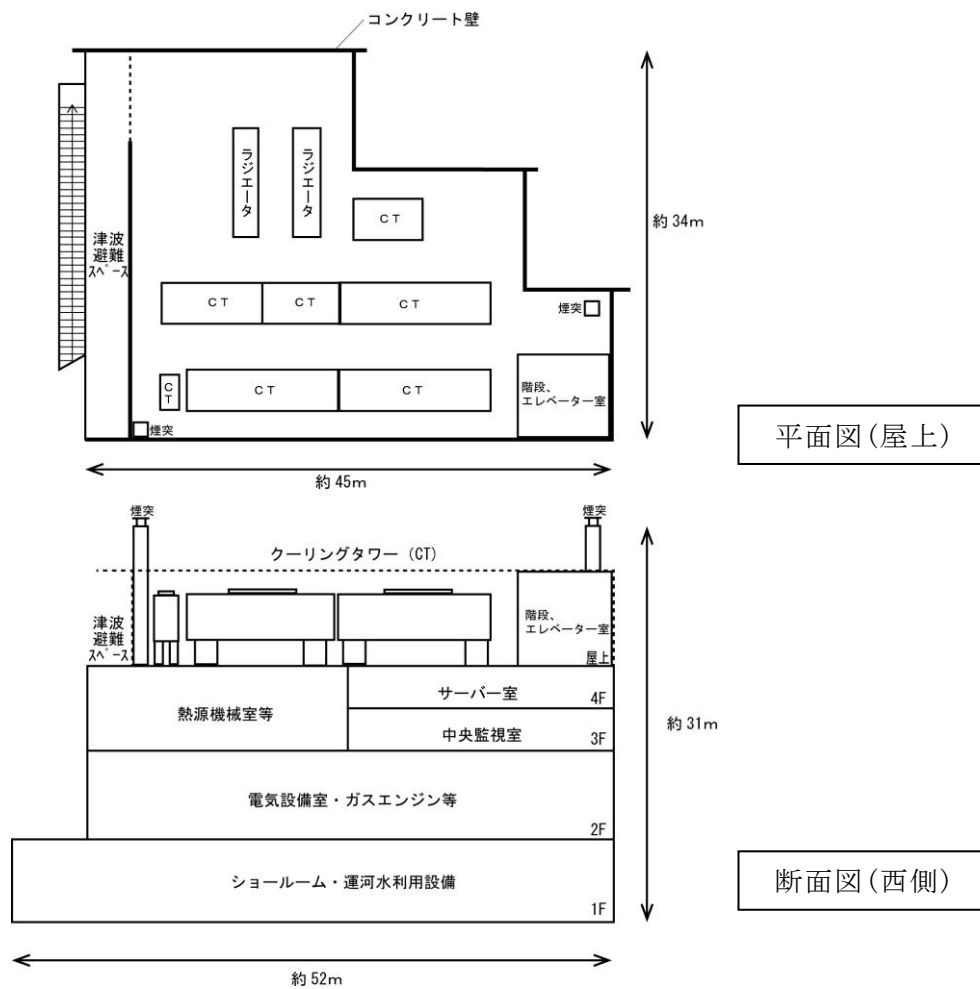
(2) エネルギー施設Aの平面図及び断面図 (変更後)
